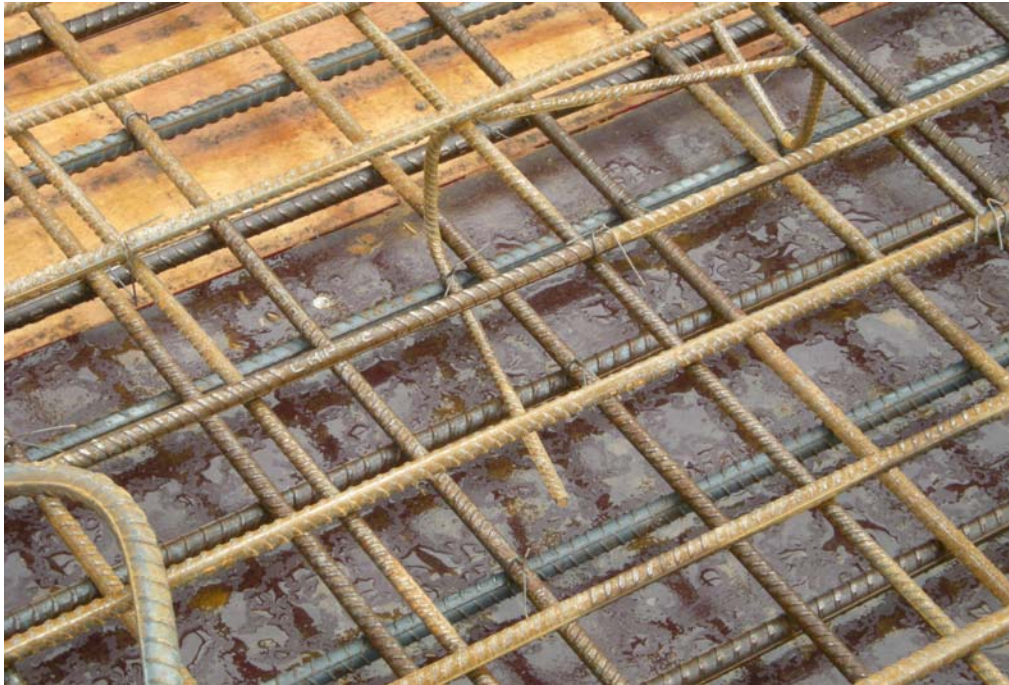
Acercamiento Armadura en Zona de Vano. Se puede apreciar la disposición de separadores entre las armaduras superiores e inferiores.
